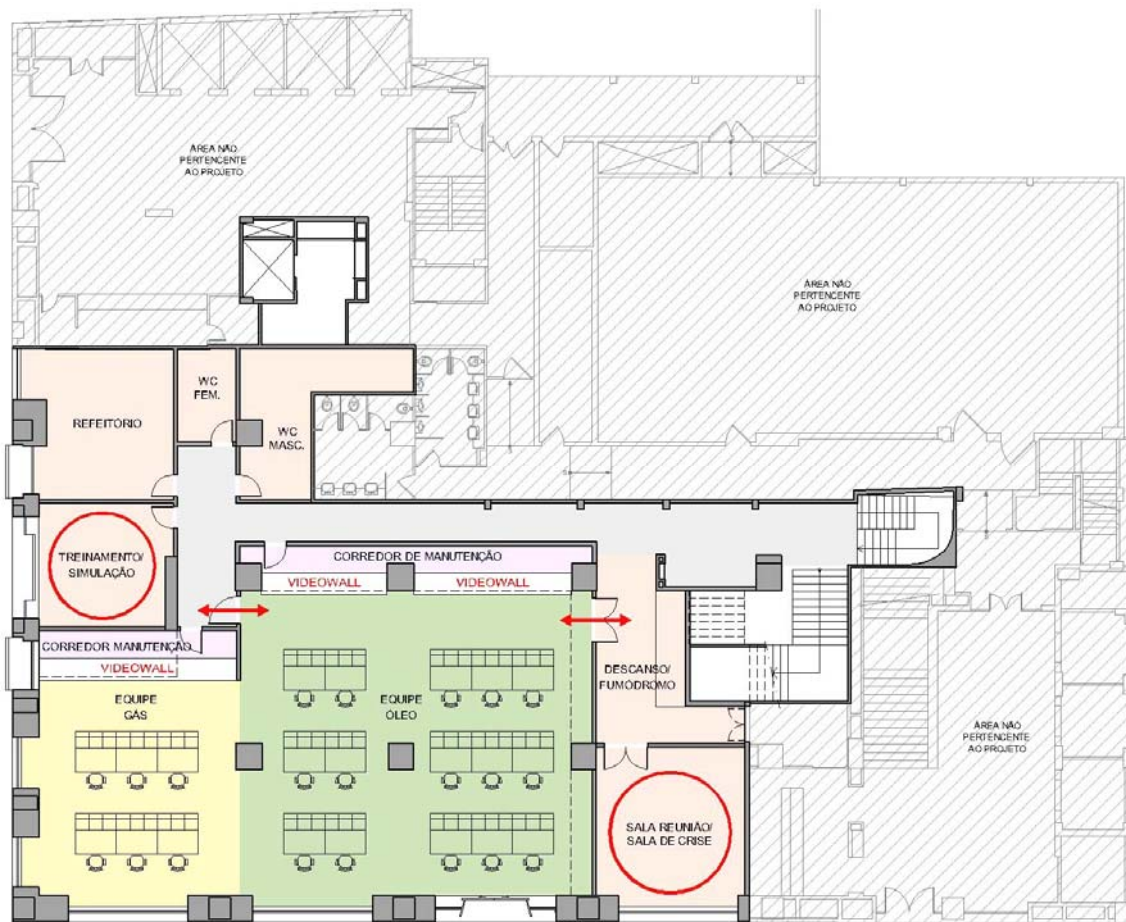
Planta baixa pavimento térreo: opção 1 para o layout (oito de junho)
